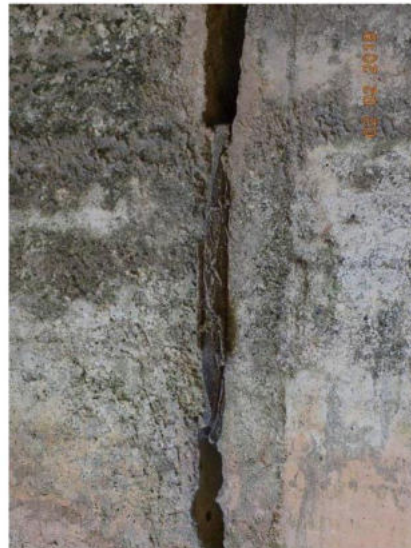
Vista do aparelho de apoio tipo Neoprene. Nota-se que o mesmo encontra-se deteriorado.
